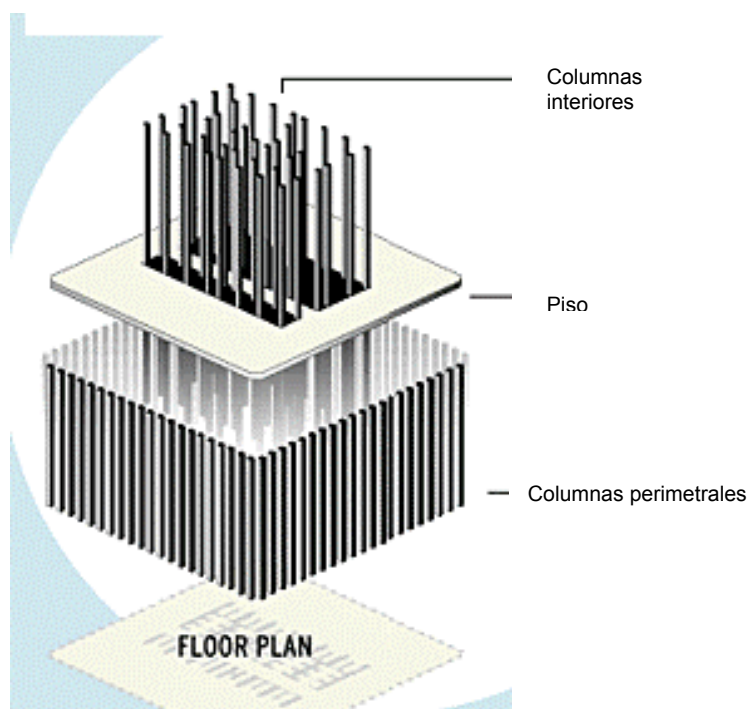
Esquema de la distribución de las columnas en las torres del World Trade Center
